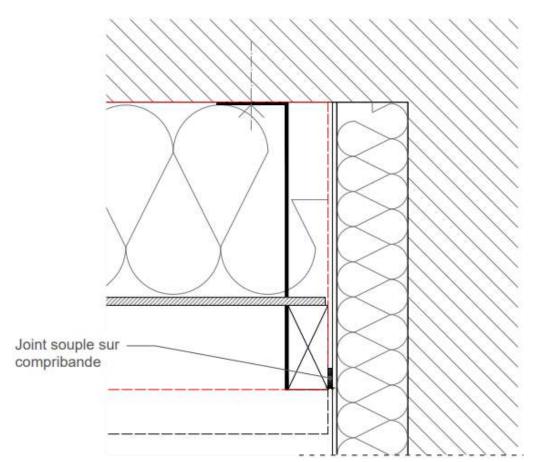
Angle rentrant entre BYWalli et enduit mince sur isolant
